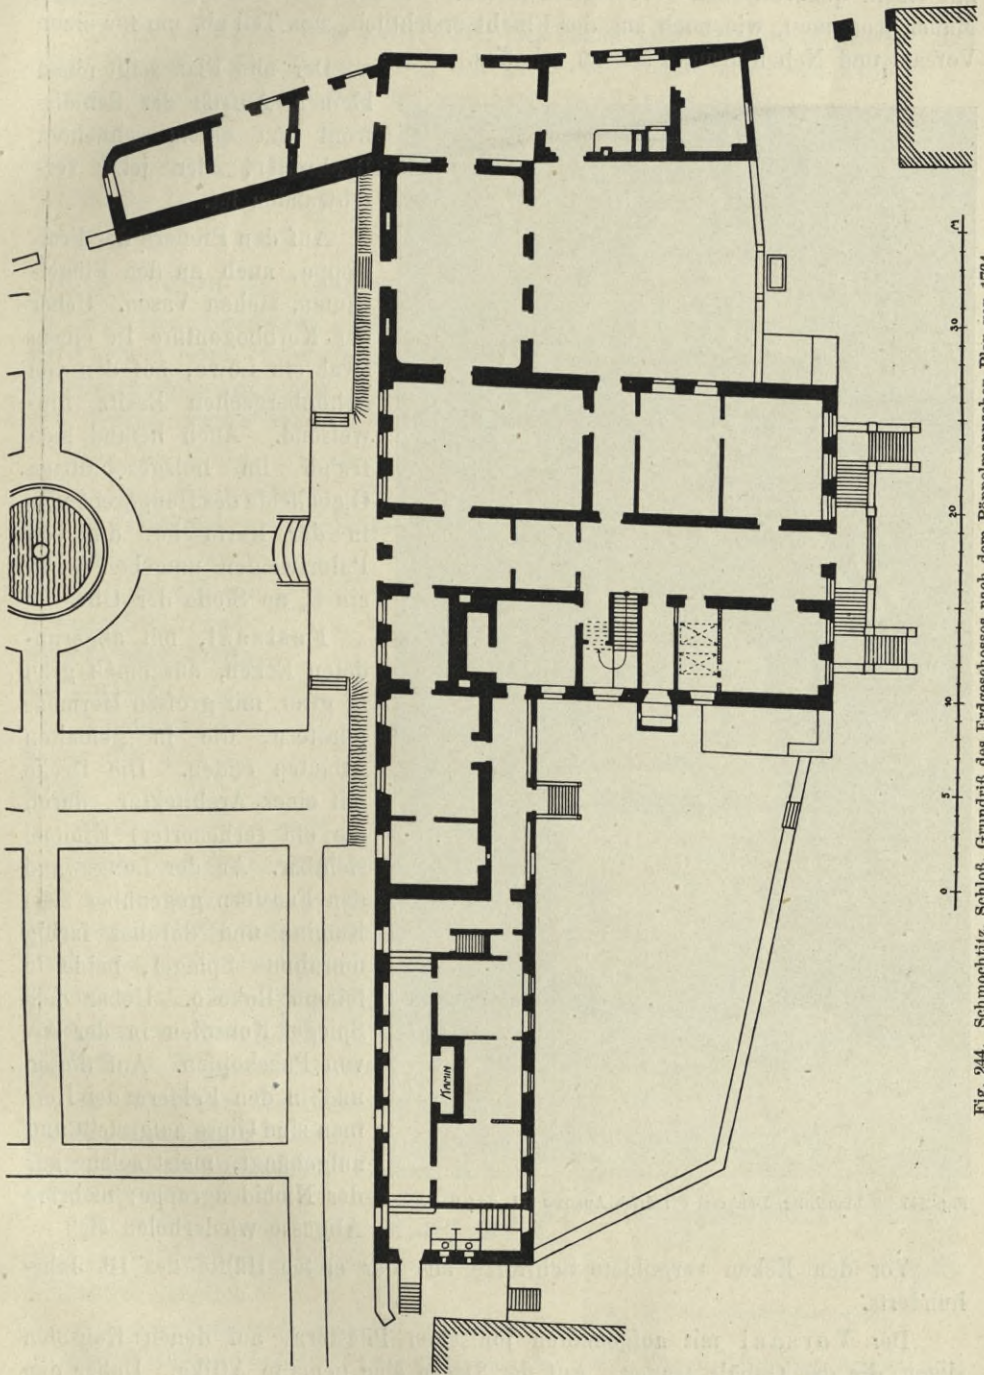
Schmoehitz, Schloß, Grundriß des Erdgeschosses nach dem Pöppelmannschen Plan von 1764.
